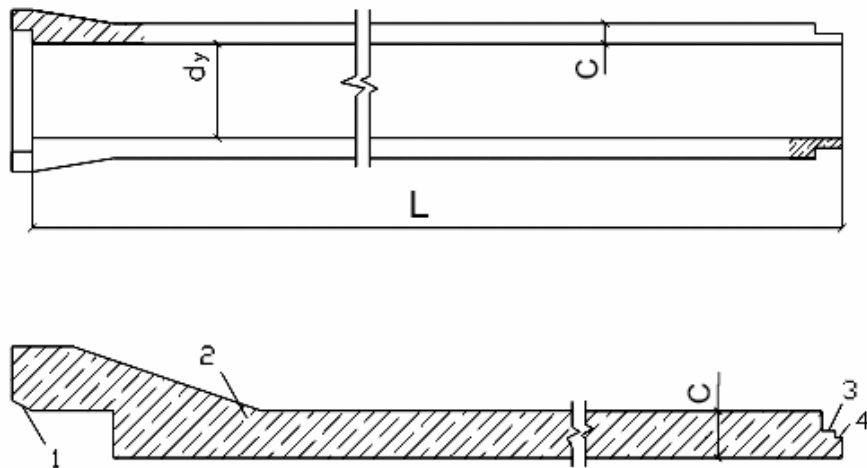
Трубы железобетонные безнапорные типа РТС:
